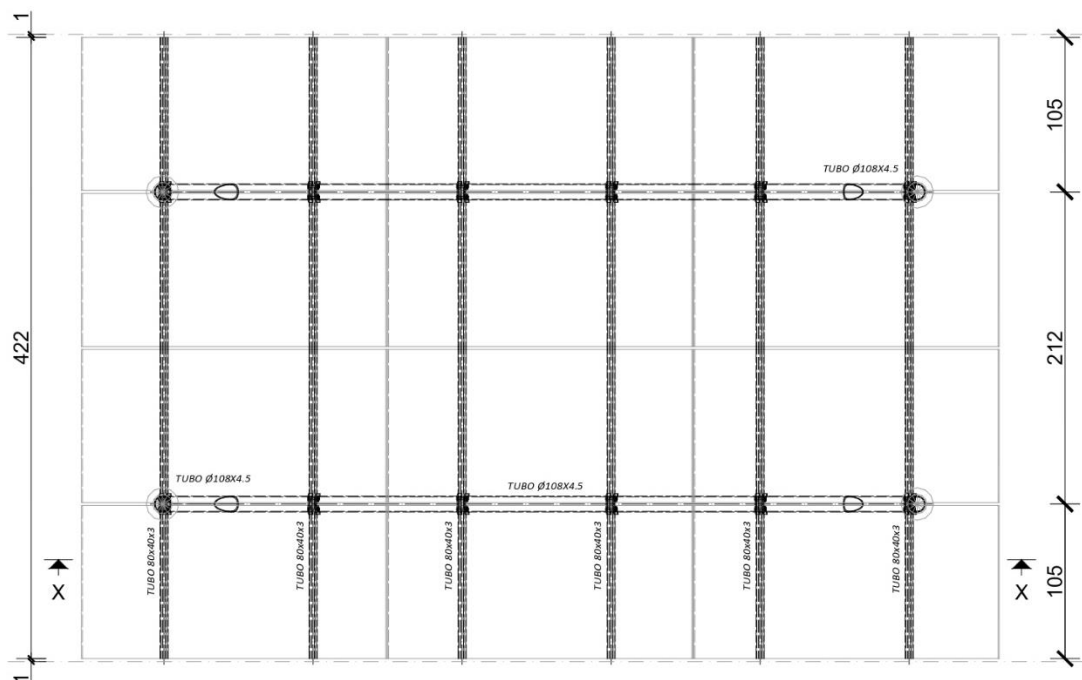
vista dall'alto struttura di sostegno metallica dei moduli fotovoltaici
